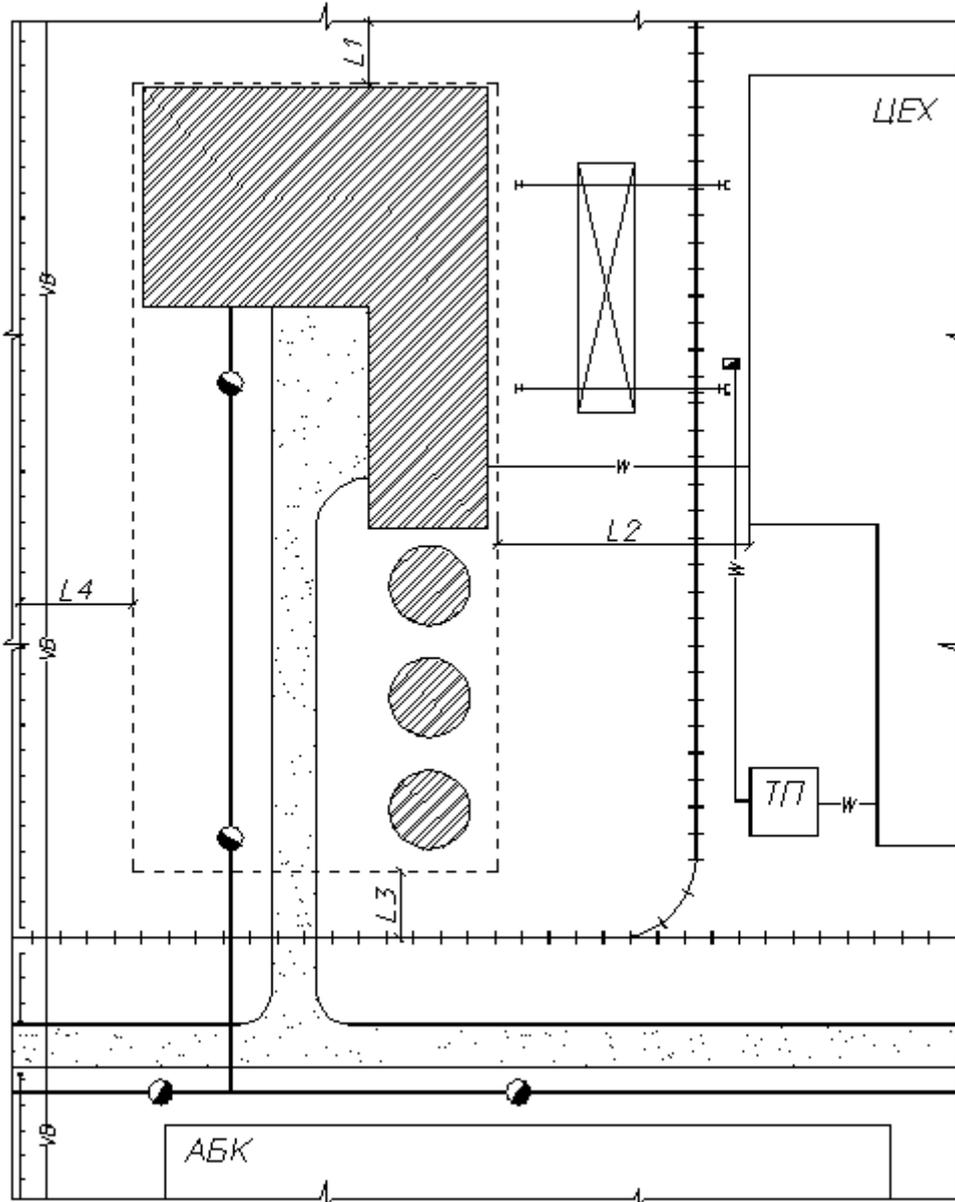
Схема Генплана одноэтажного промздания (вариант 1)
